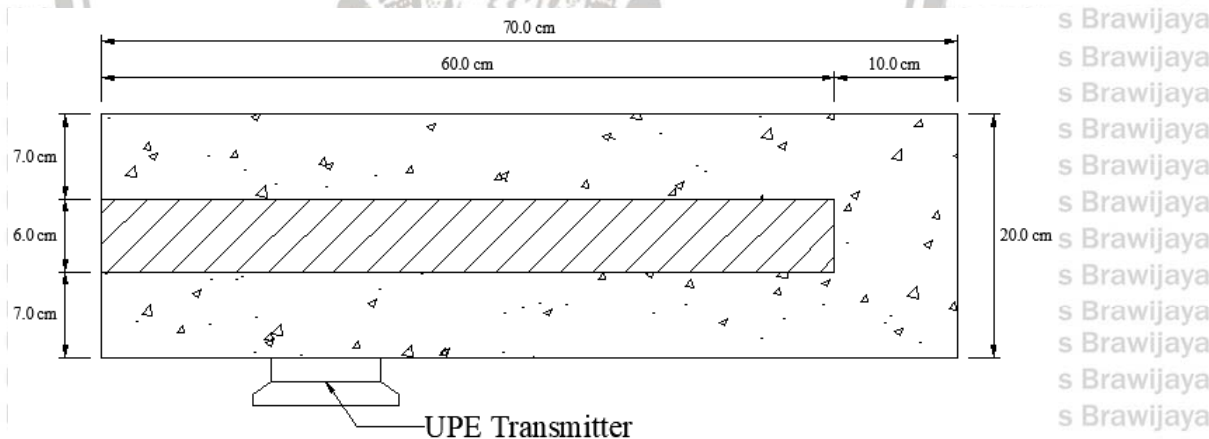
titik pengujian b-scan beton dengan lubang arah longitudinal
